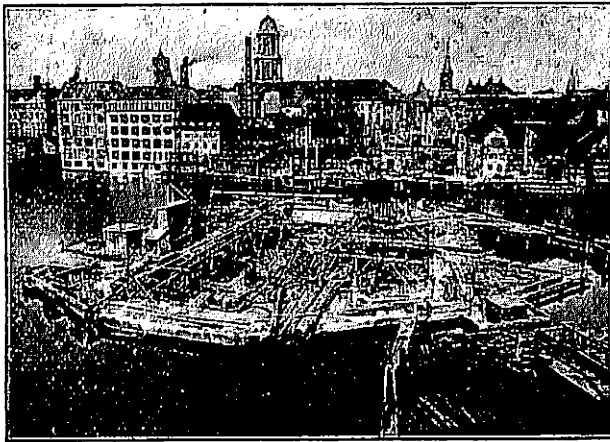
Spreekreuzung Inselbrücke, Bauabschnitt III (nach J. Bousset).
